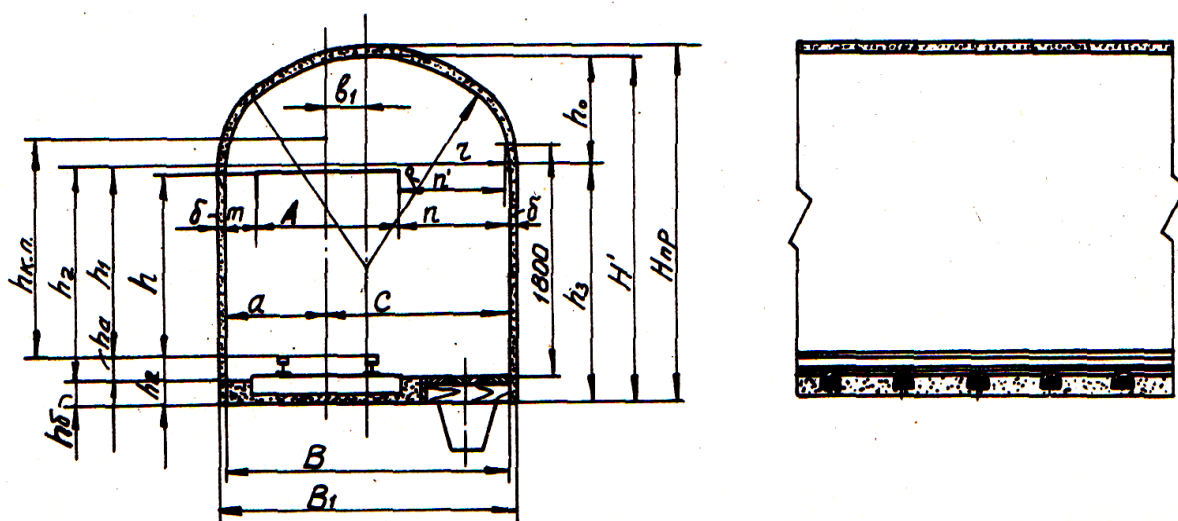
Конструкция набрызг-бетонной крепи
